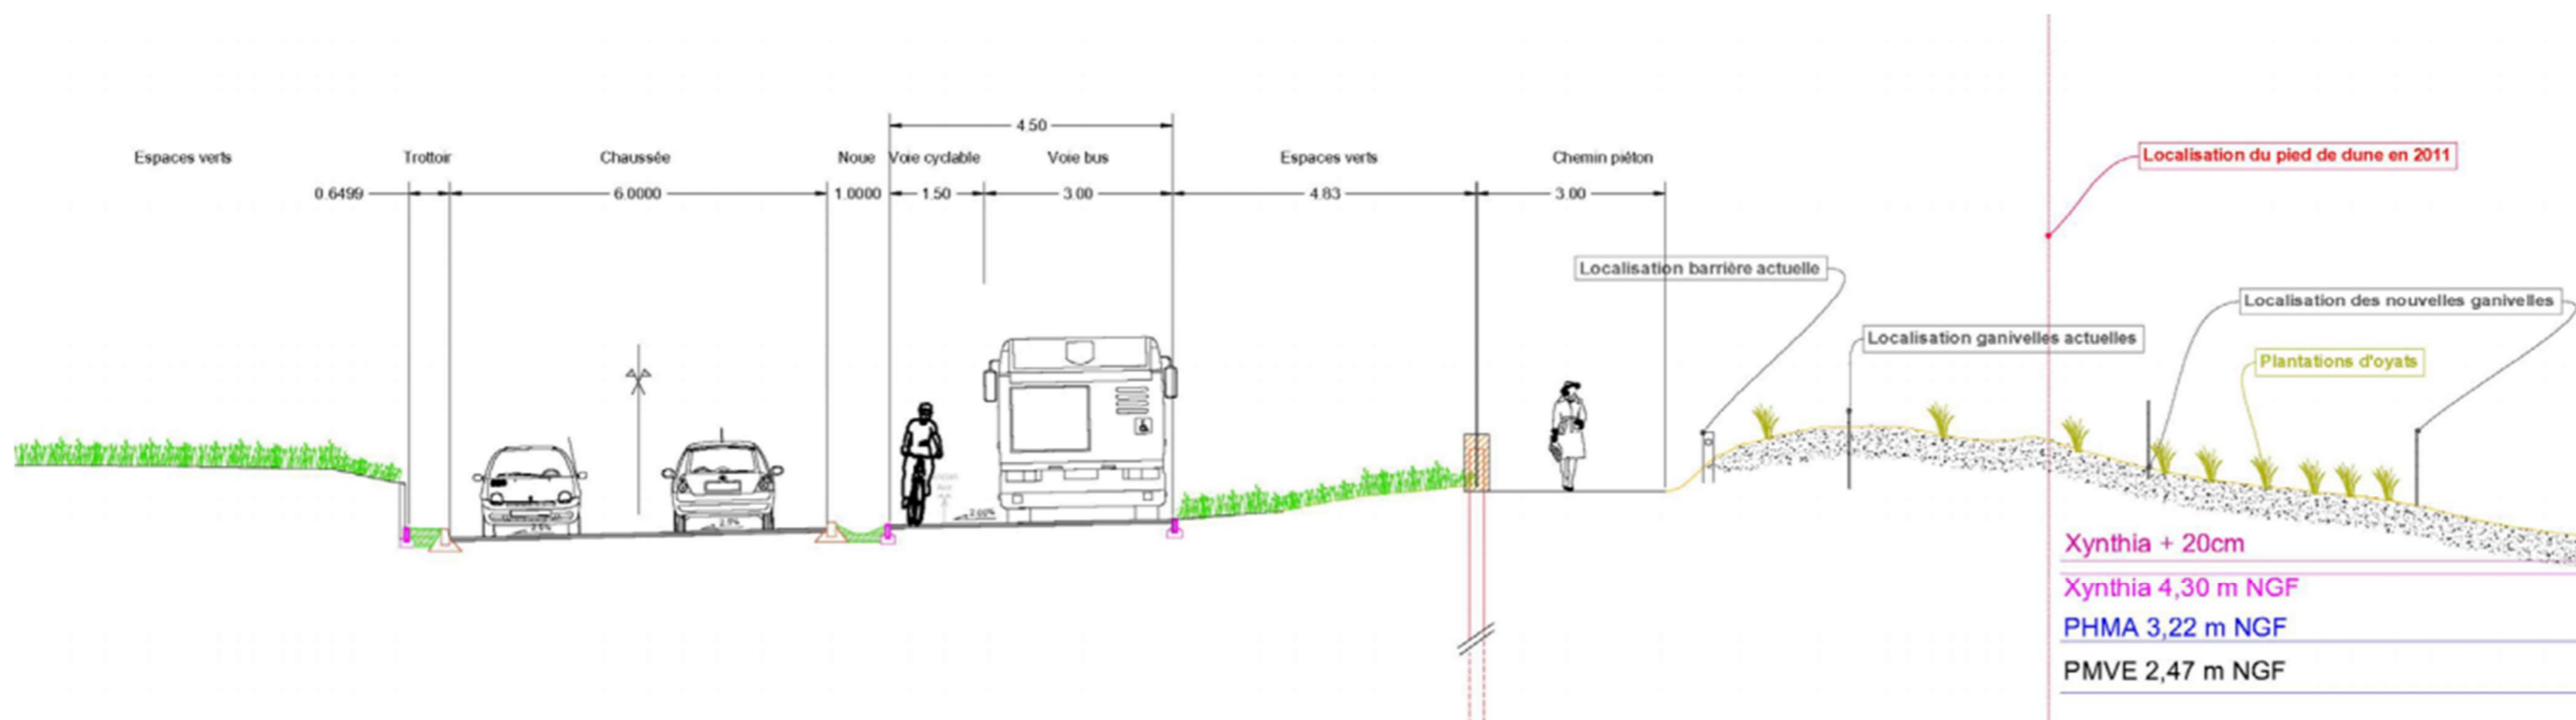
Profil en travers confortement RD201 avec le scenario 2 : protection en palplanches, projet « 3. Système de protection de côte du virage du défend »
